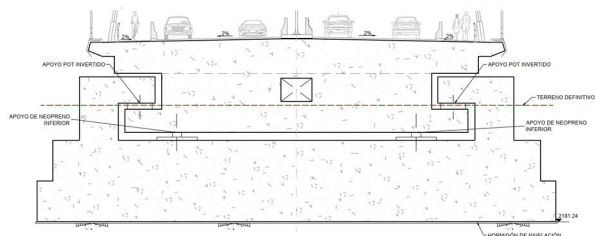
Sección transversal de un estribo. Fuente: TYPESA.
